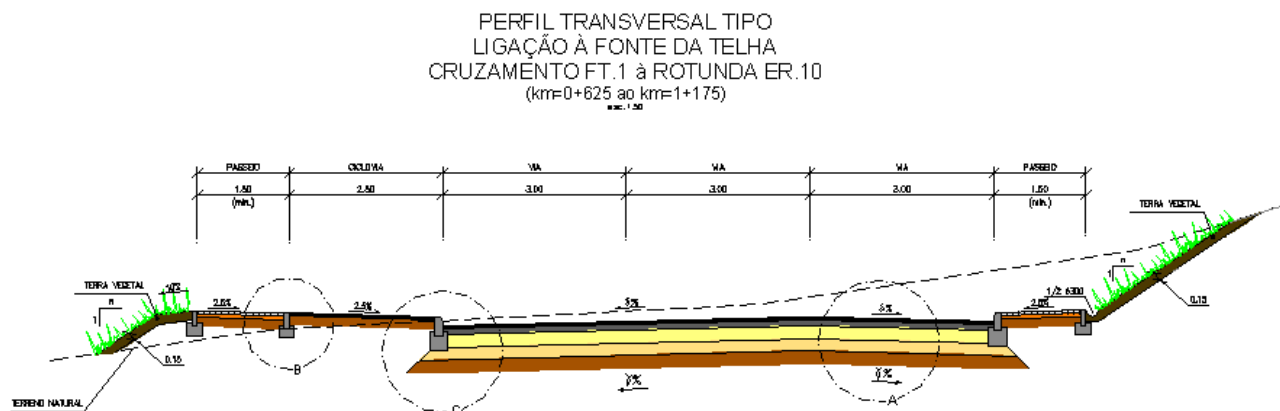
Perfil Transversal Tipo do troço entre o Cruzamento FT.1 e a Rotunda ER.10
